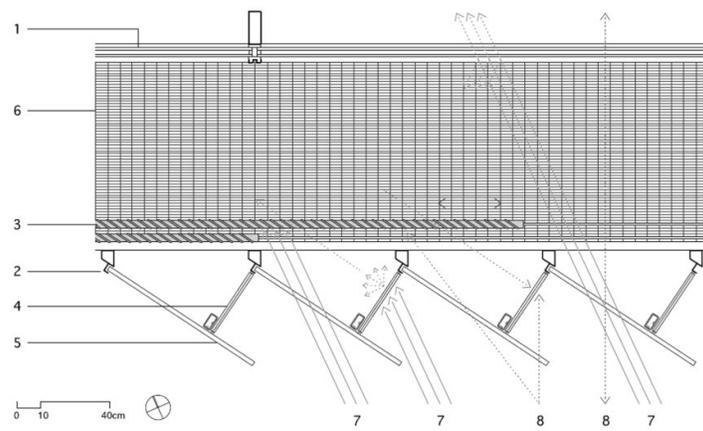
Detalhe do brise. (Nachhaltiges bauen, 2011).
